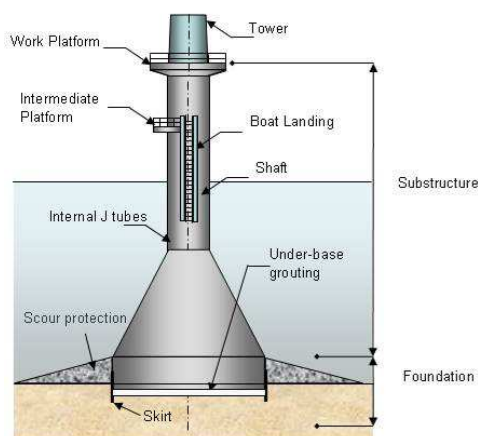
Subestructura marina de tipo zapata. Cimentación por gravedad
